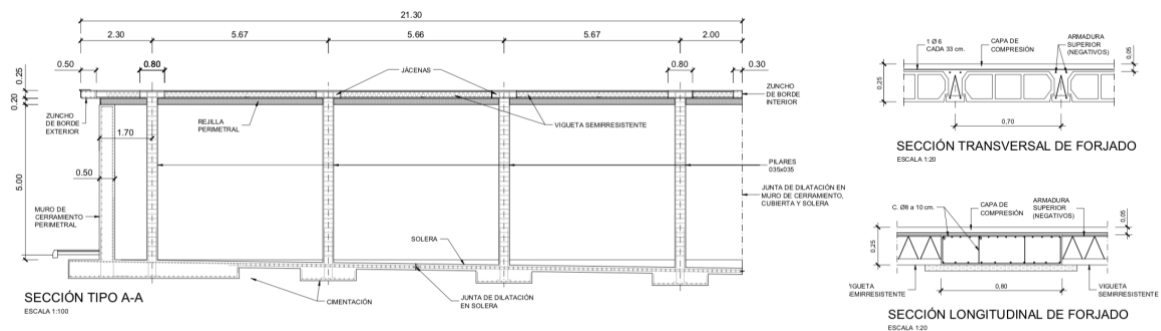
Plano 03.1 Detalles y secciones del estado actual del depósito. Disponible en el doc. Nº 2. Planos.
